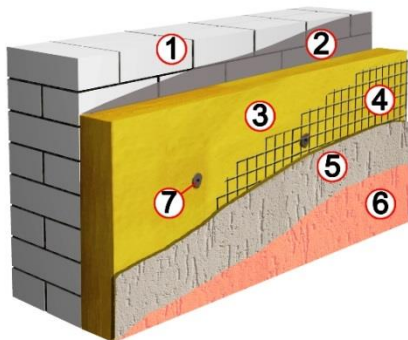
Фасад зі штукатурним шаром (утеплення «мокрим» методом
